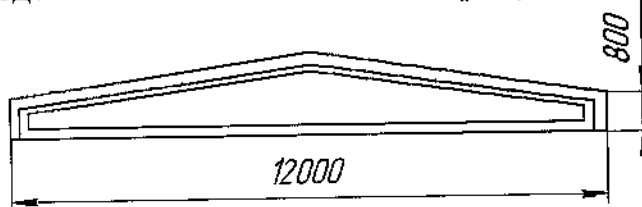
Железобетонная ферма серии 1.462-3
